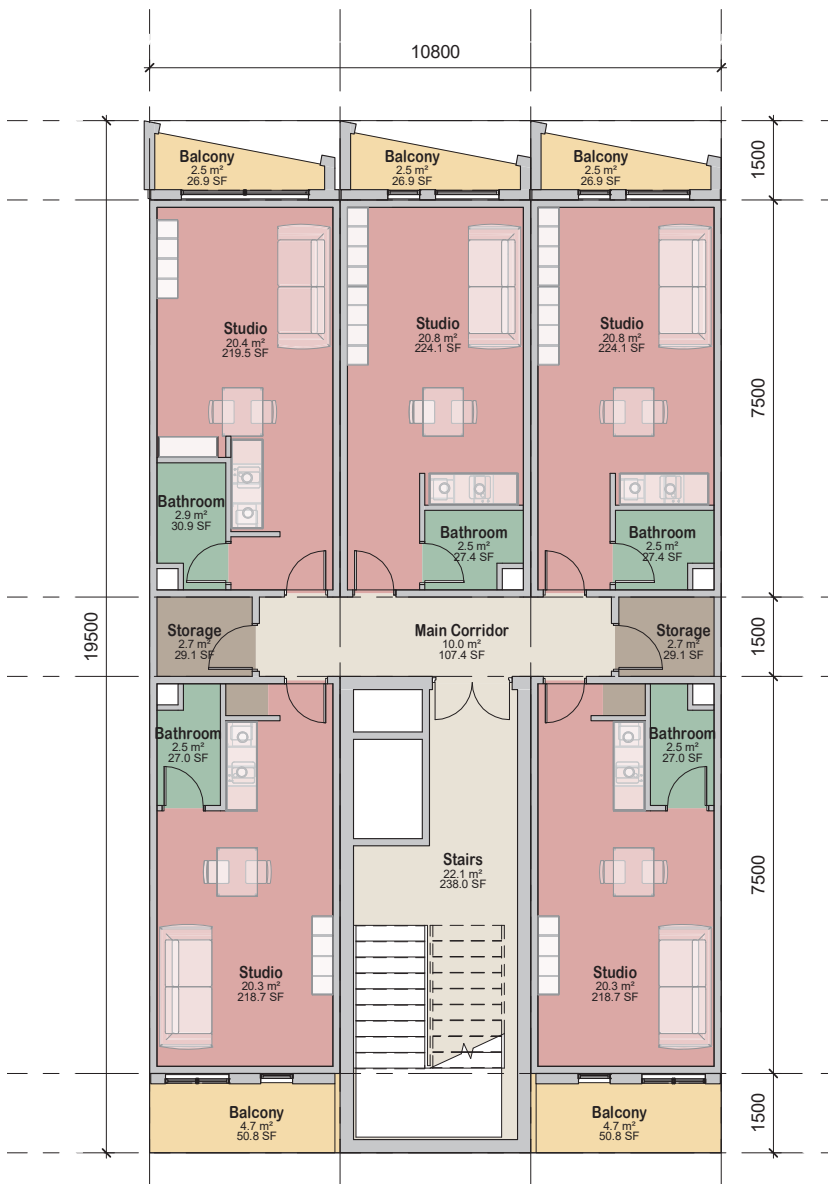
Концепція плану будівлі ущільнювальної забудови №3 / масштаб 1:200
